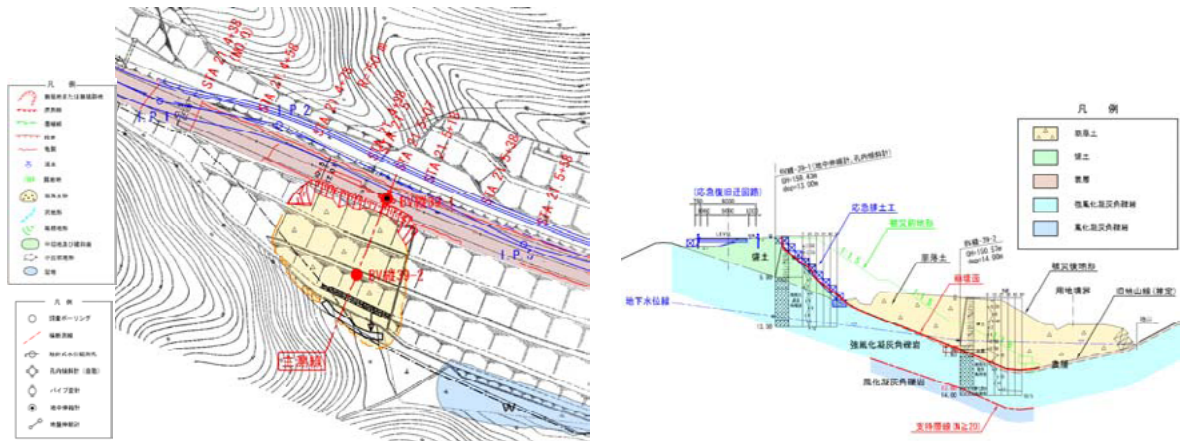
崩壊箇所平面図及び主断面図 その1 (能登有料 穴水町越の原その2 21.5kp 縦-39) ²⁾
